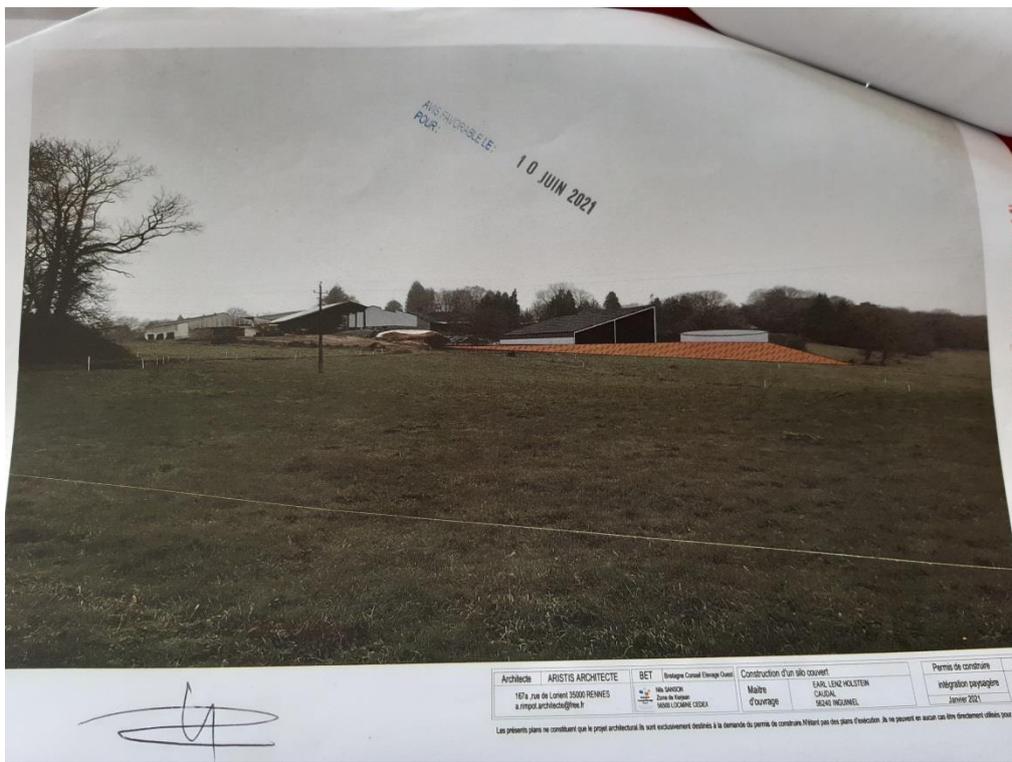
photo du projet de fosse et hangar soja vu de la route principale
